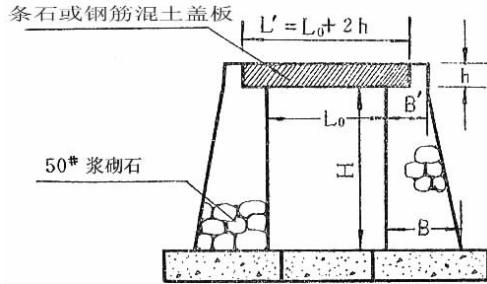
条石或钢筋混凝土盖板的砌石方涵示意图
